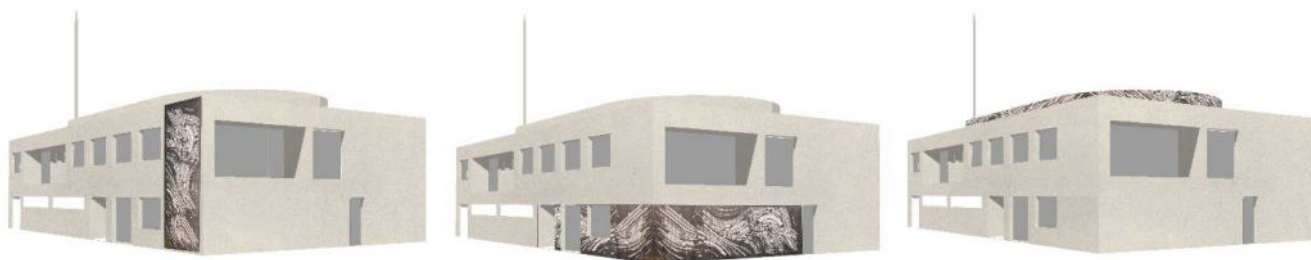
Ipotesi di posizionamento dell'opera d'arte
